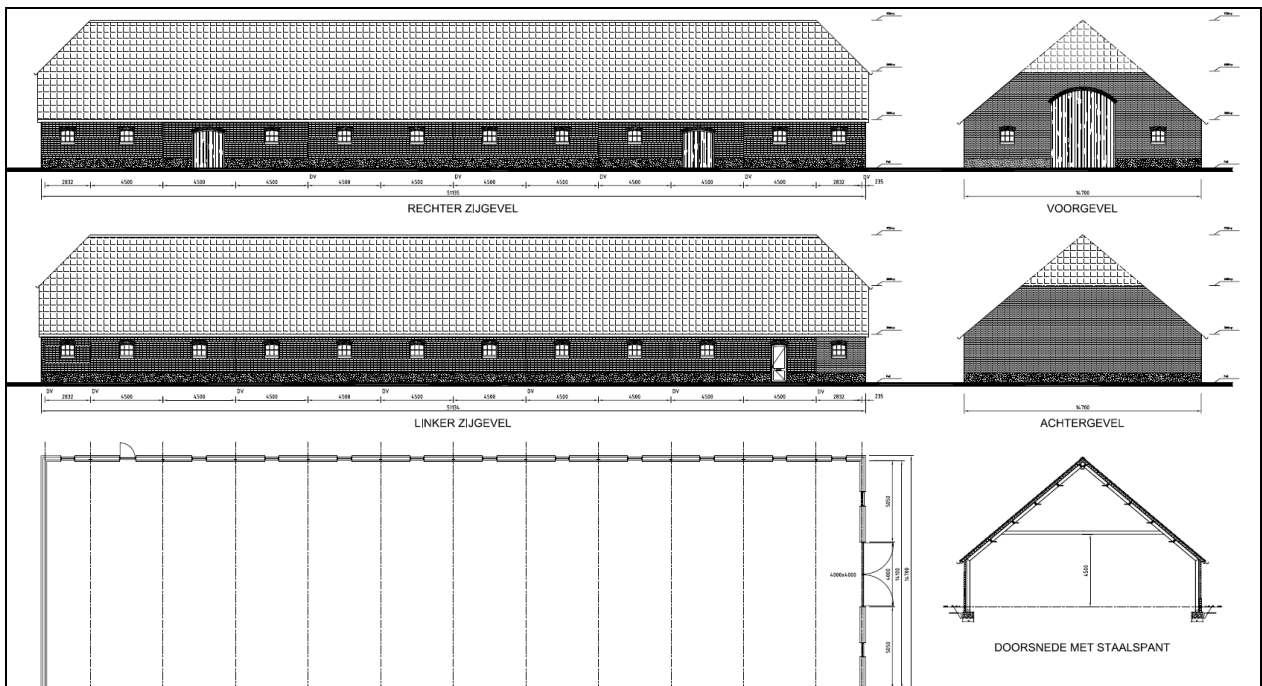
Zijaanzicht van de beoogde Bed & Breakfast
